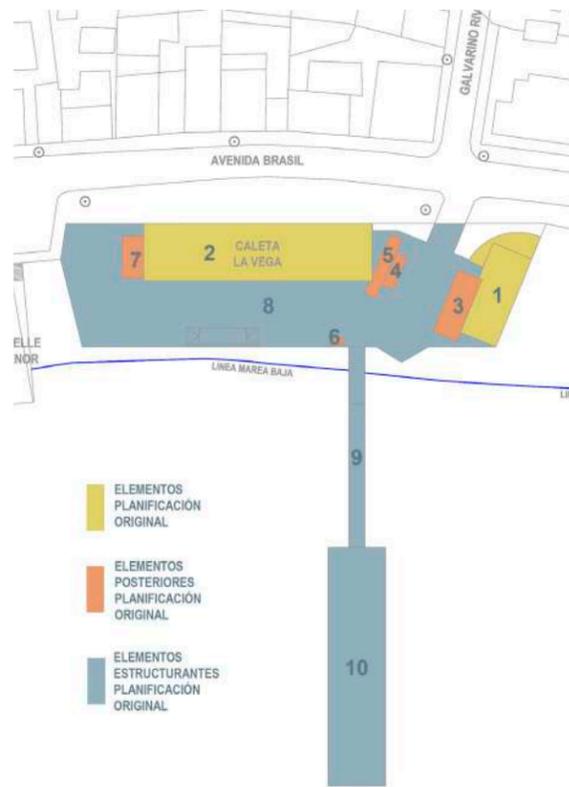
Elaboración propia. Plancheta Calbuco DOM.
